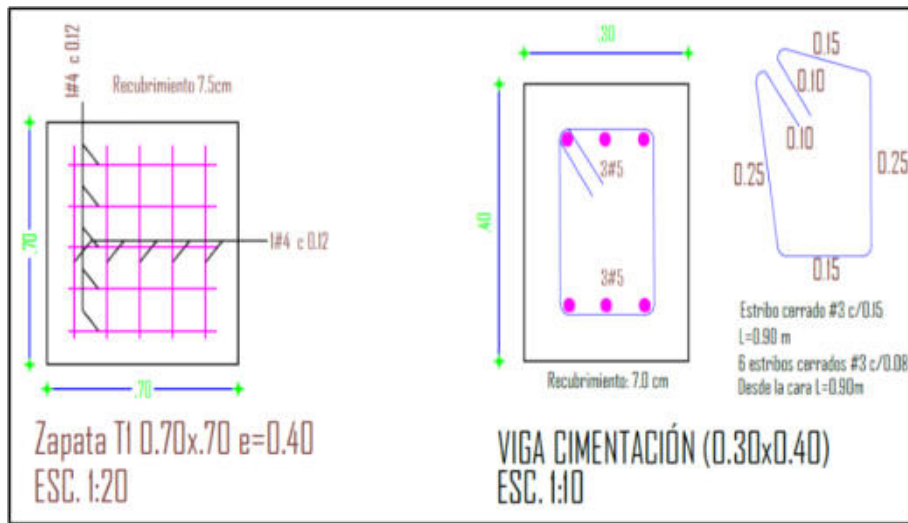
Detalle zapatas y viga de cimentación para las casas
